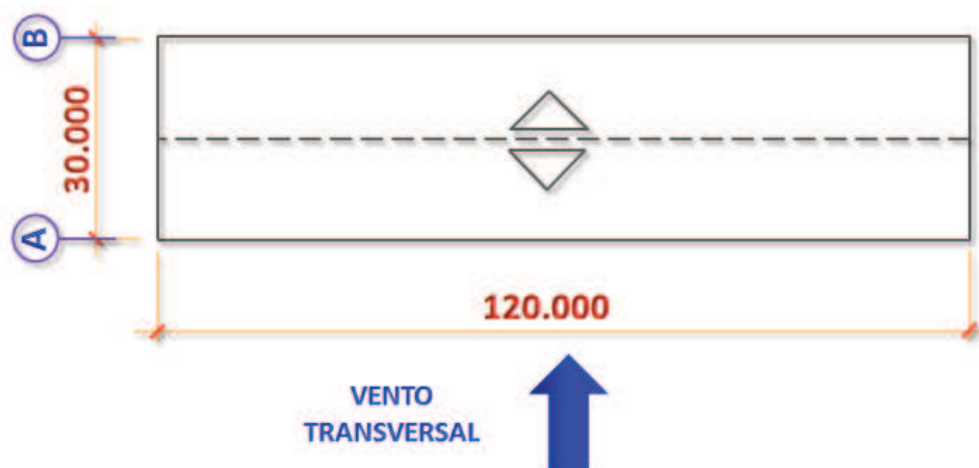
Planta da cobertura do edifício industrial em estudo, sob a atuação do vento transversal.
